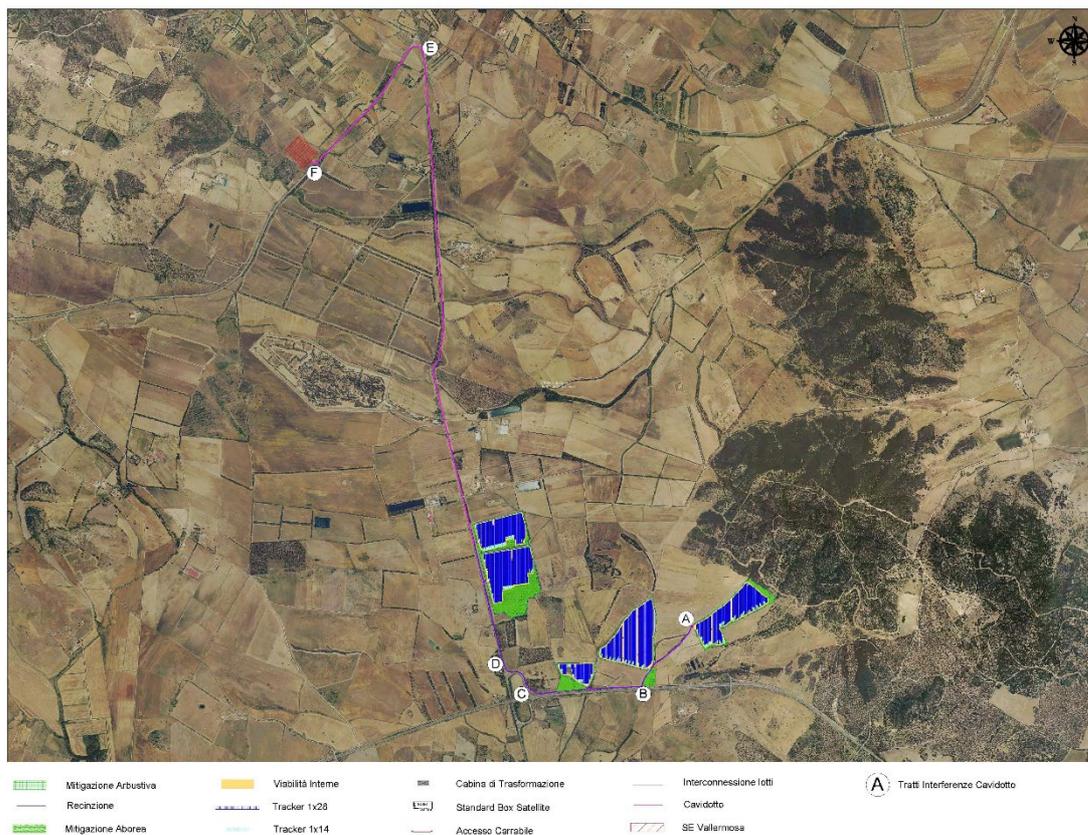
Tratti stradali attraversati dal cavidotto interrato del futuro impianto FV_SILIQUA
